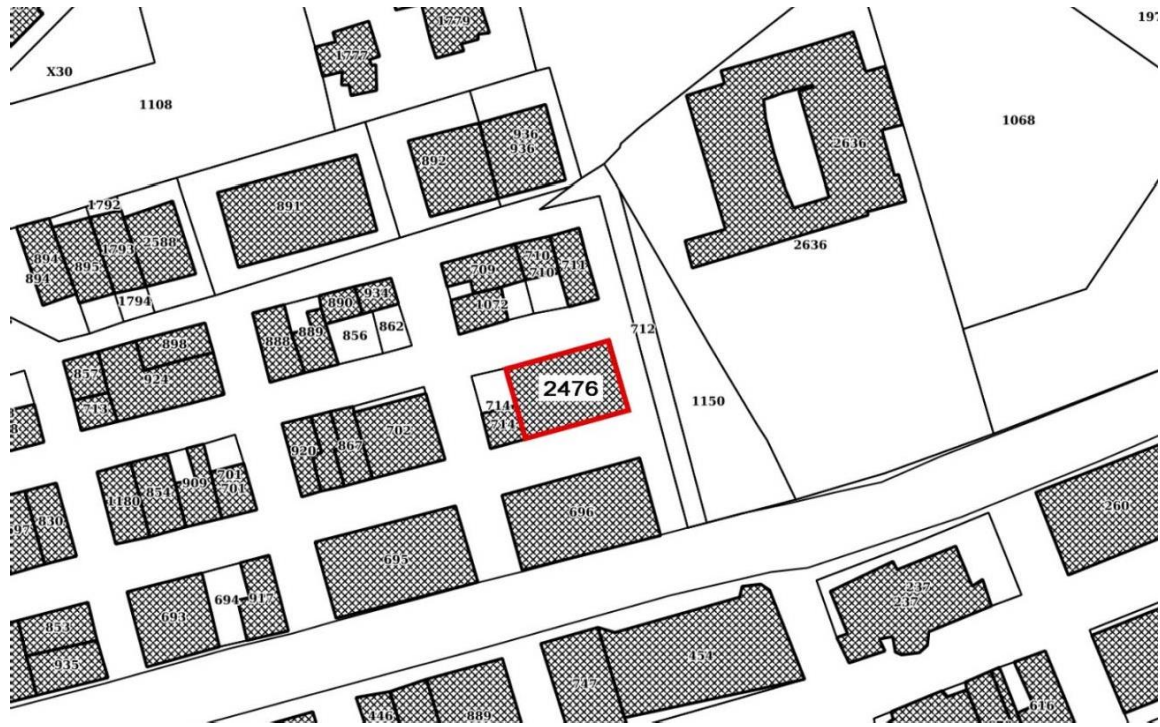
Stralcio Planimetria Catastale. Foglio 48 – P.Ila 2476
